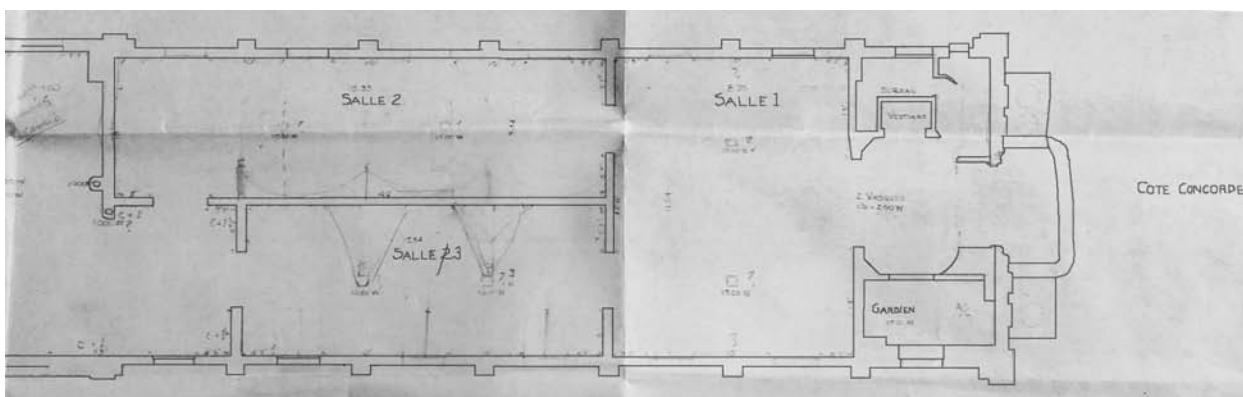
pianta del piano terra, impianto luci, 1938. Lato Concorde e corpo centrale. Archives Nationales, Cote 20144707/96.
